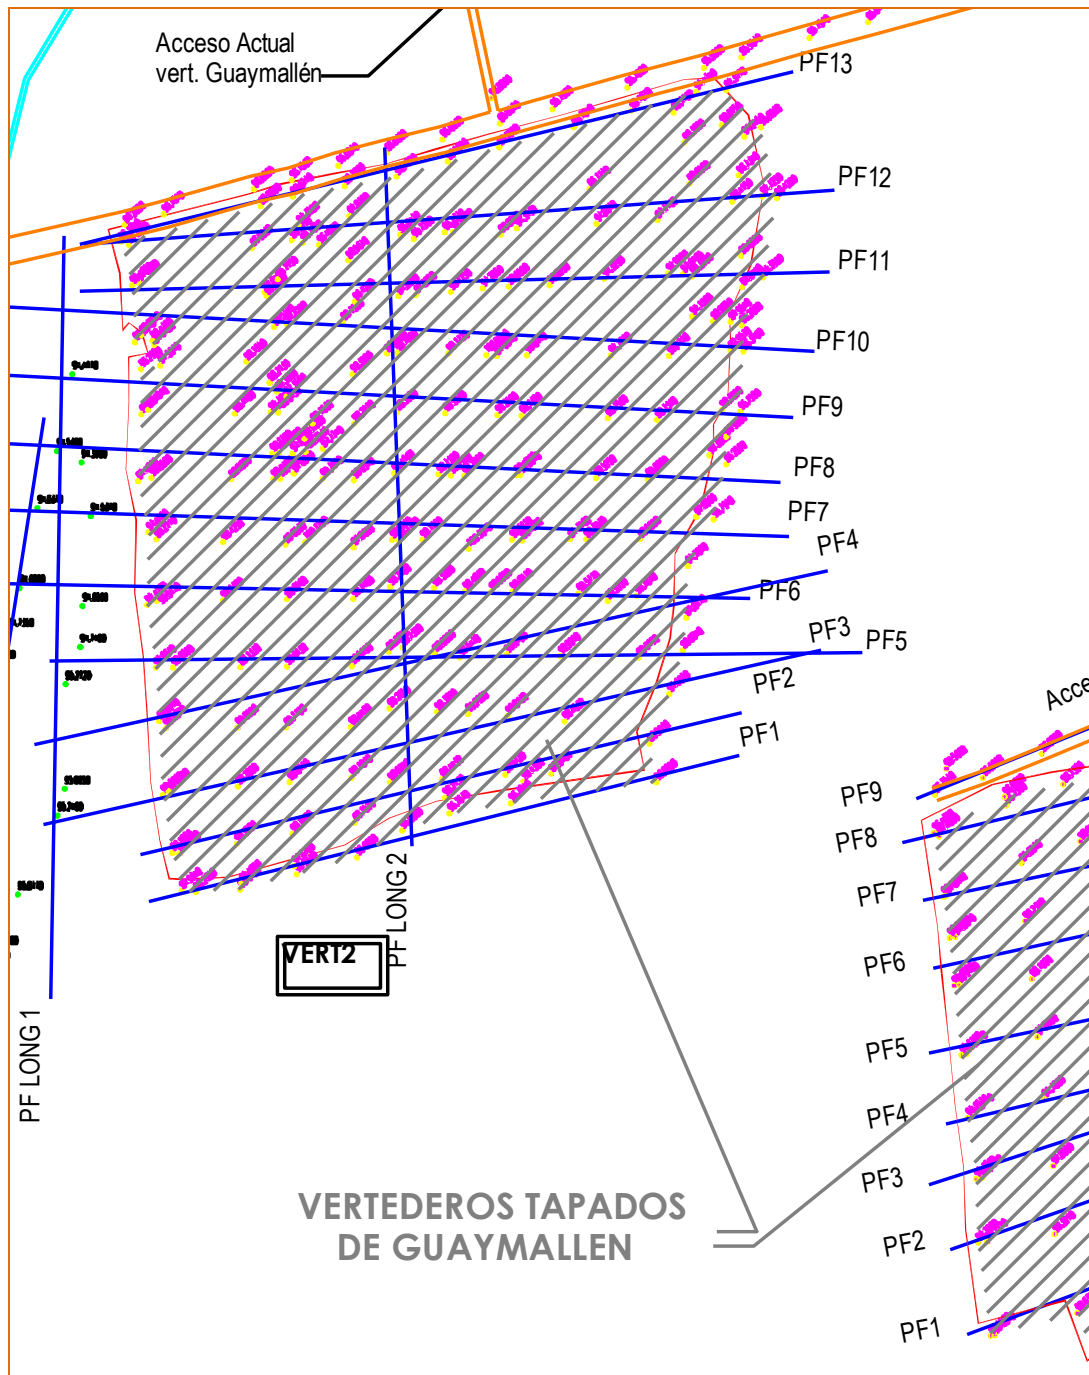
Detalle de la Planimetría Antiguo Vertedero de Gillén – Sector Norte - VERTEDERO N°2
